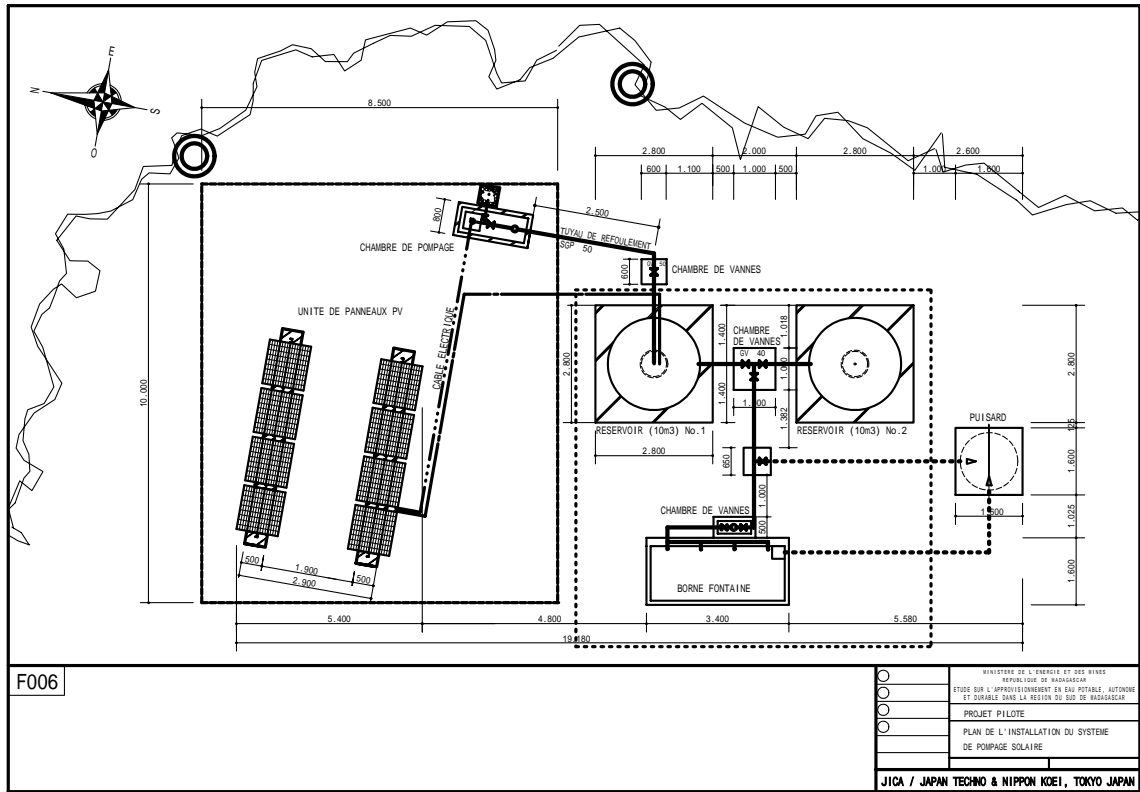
Plan de l'installation du système de pompage solaire
